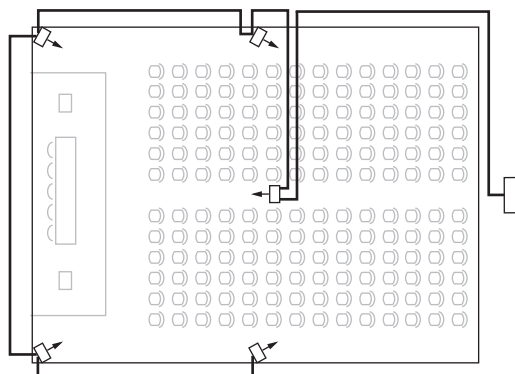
Disposição assimétrica do cabeamento do radiador (a ser evitada)
